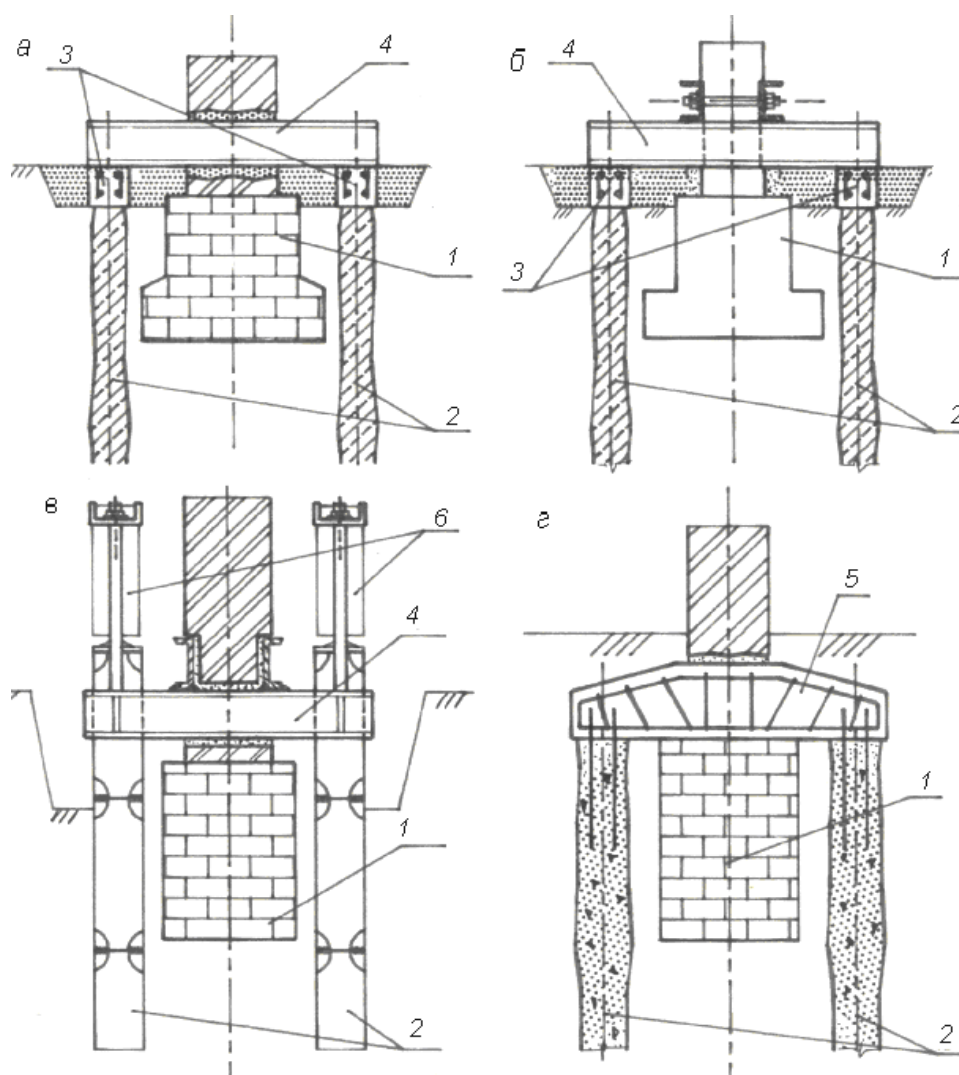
Усиление фундаментов сваями с применением стальных и железобетонных поперечных балок: а – ленточного фундамента; б – столбчатого фундамента; в – усиление многосекционными сваями: г – с применением железобетонной балки: 1 – существующий фундамент; 2 – сваи усиления; 3 – железобетонный ростверк; 4 – стальная балка; 5 – железобетонная балка; 6 – домкраты
